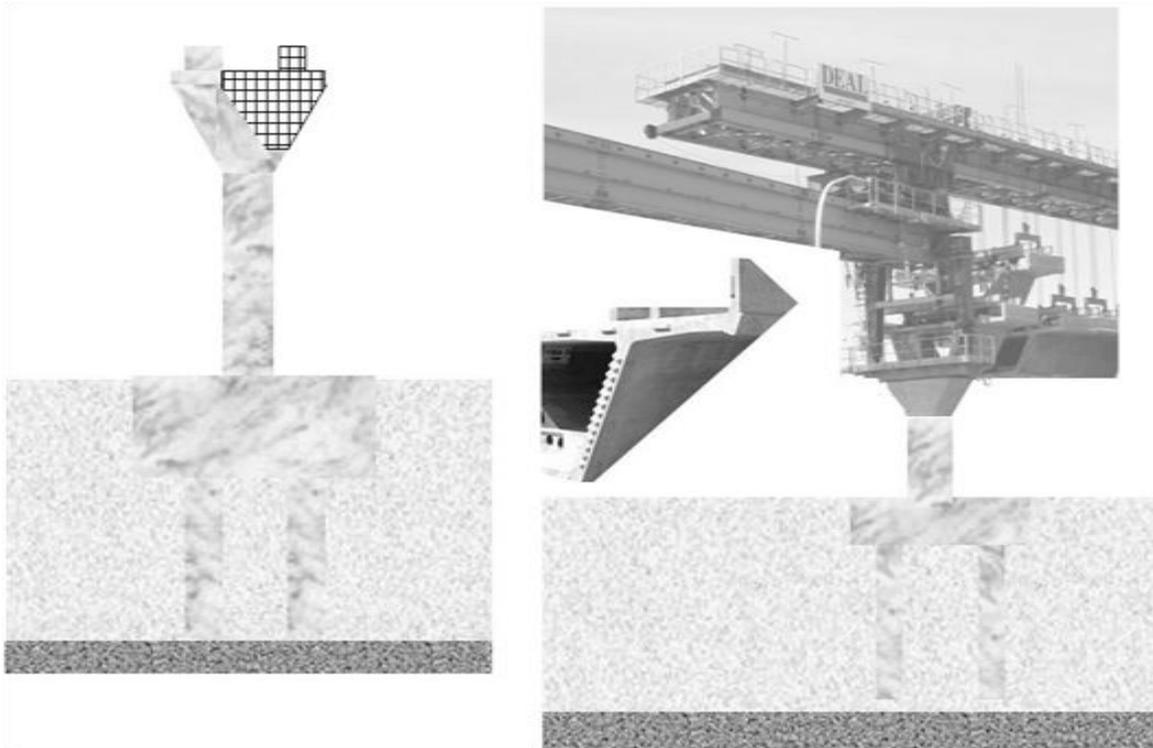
; *Se observa la estructura, una sección de dovela y el montaje de la viga lanzadora.
